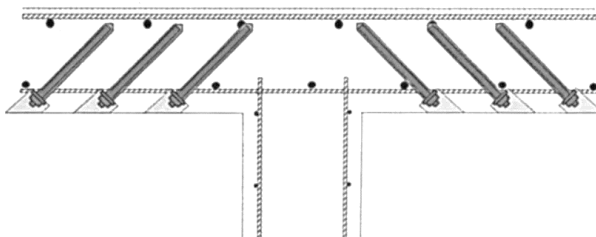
Схема усиления плит дополнительной вклеенной поперечной арматурой, ориентированной под углом 45° к плоскости плиты
